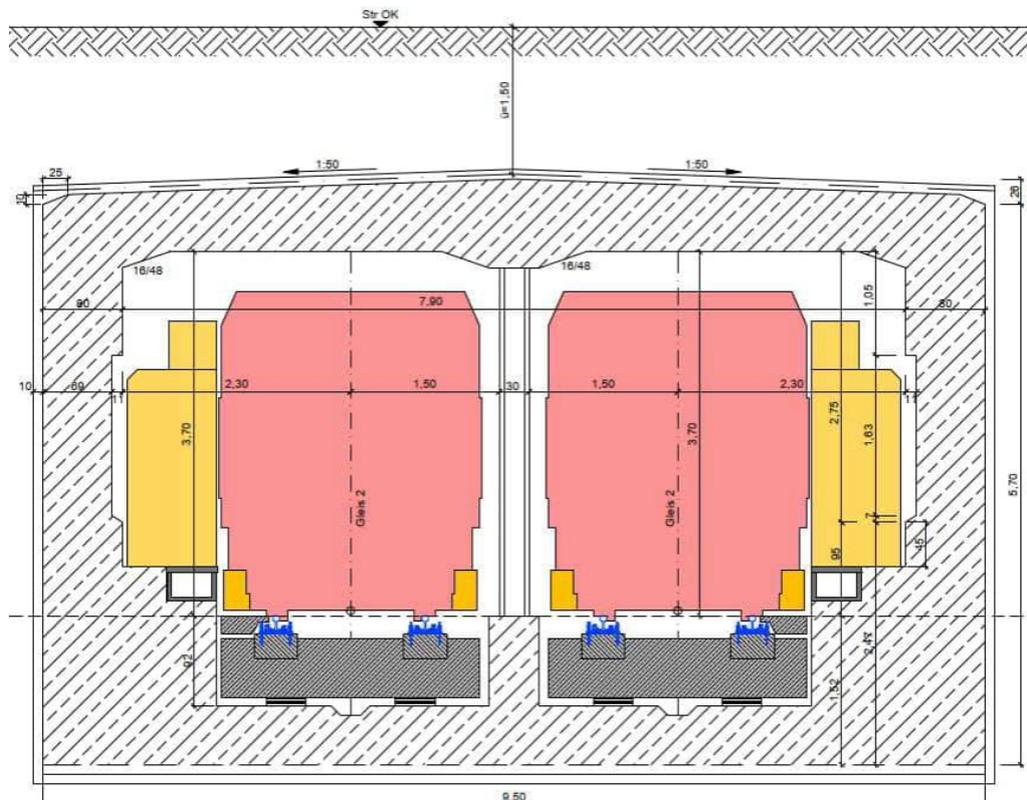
RQS Offene Bauweise, mit Rettungswegen gemäß Entwurf DIN 5647
